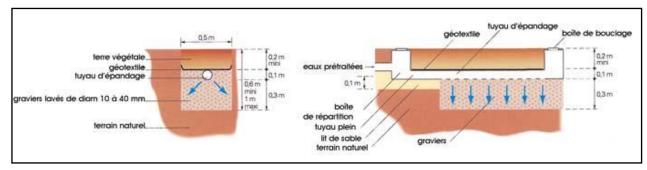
Schéma d'une tranchée d'infiltration (landru.fr)
